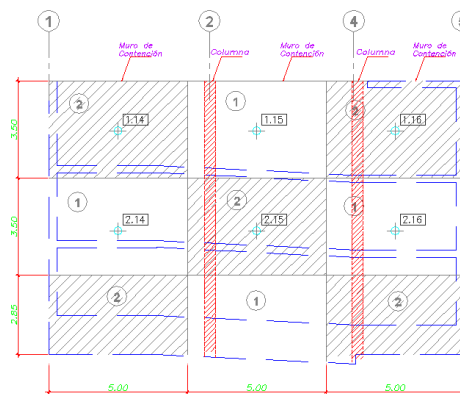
Detalle de ubicación de Placas y Columnas en Muro Anclado en “Eje A”.
